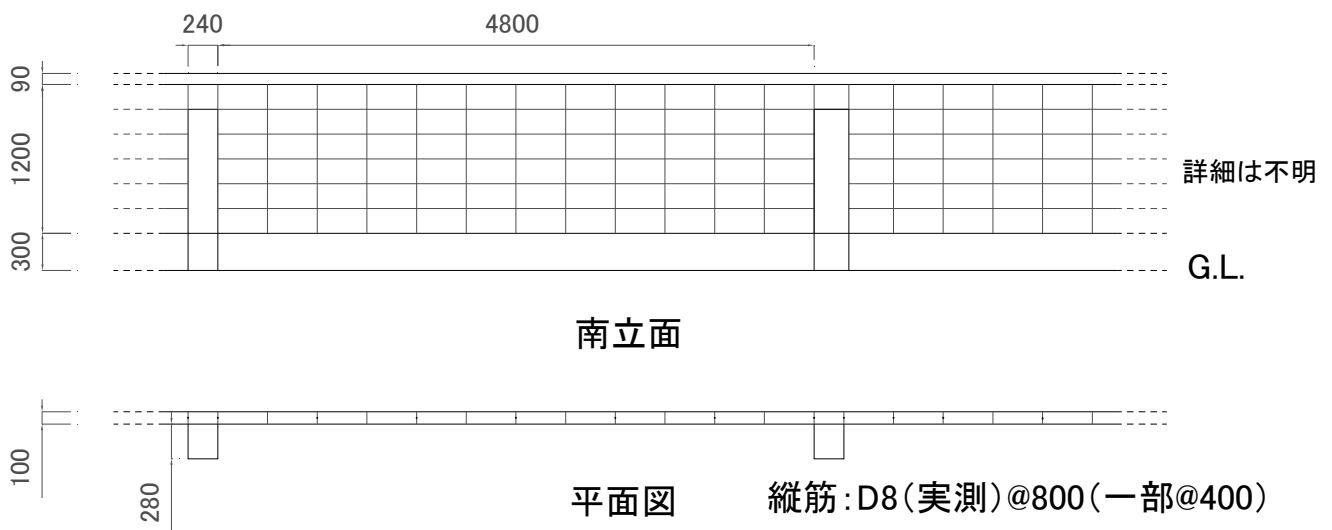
CB 塀の立面図 (単位: mm)
